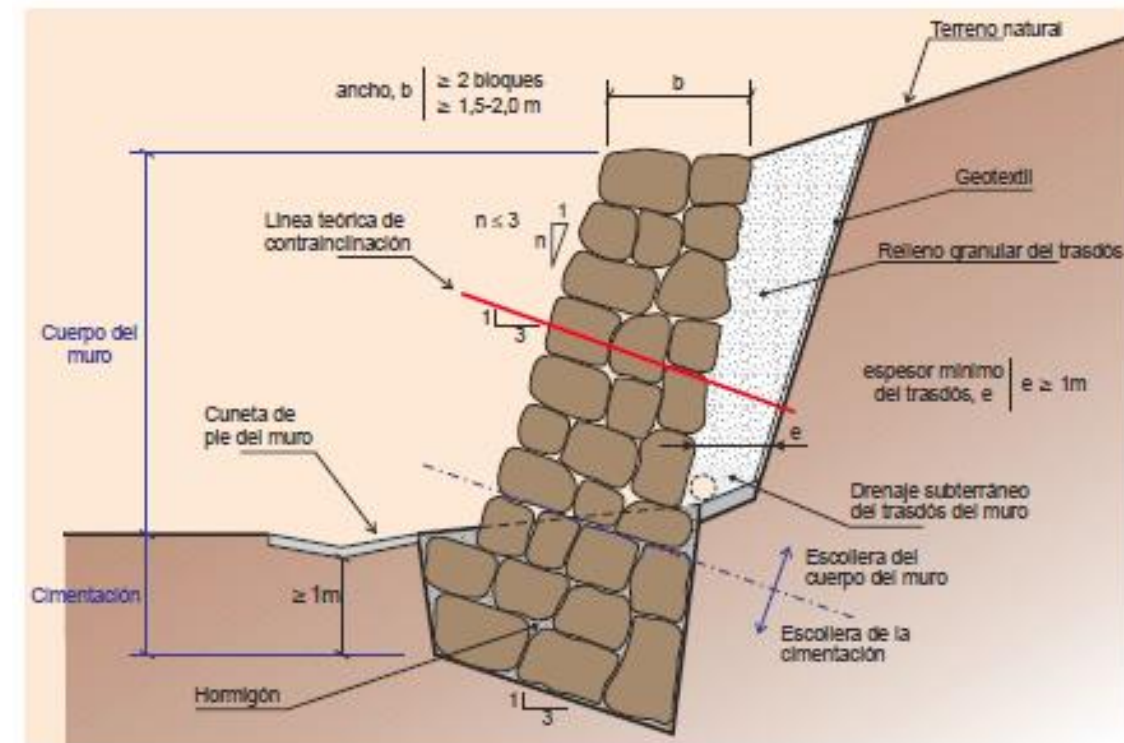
Esquema de geometría para los muros de escollera. Fuente: Guía para el proyecto y ejecución de muros de escollera en obras de carretera.
